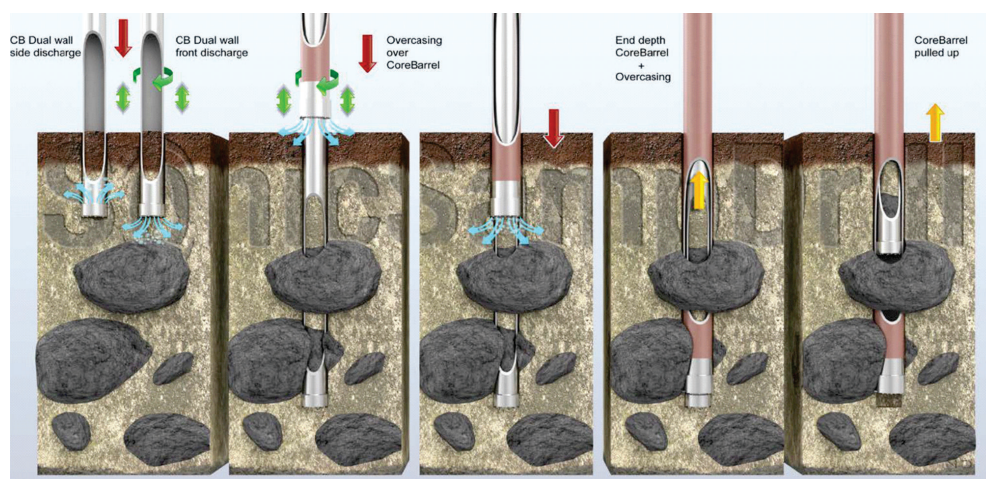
Funcionamento esquemático do *DualWall CoreBarrel*.
